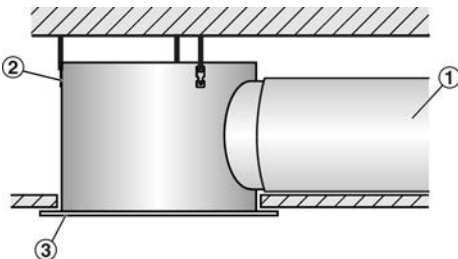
Deckenbündiger Einbau mit rundem Anschlusskasten
